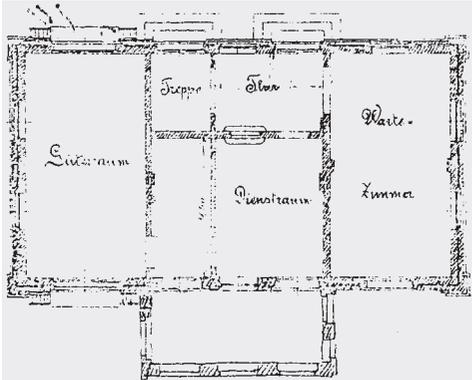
Grundriss alt nach 1906“, Slg. IGB
